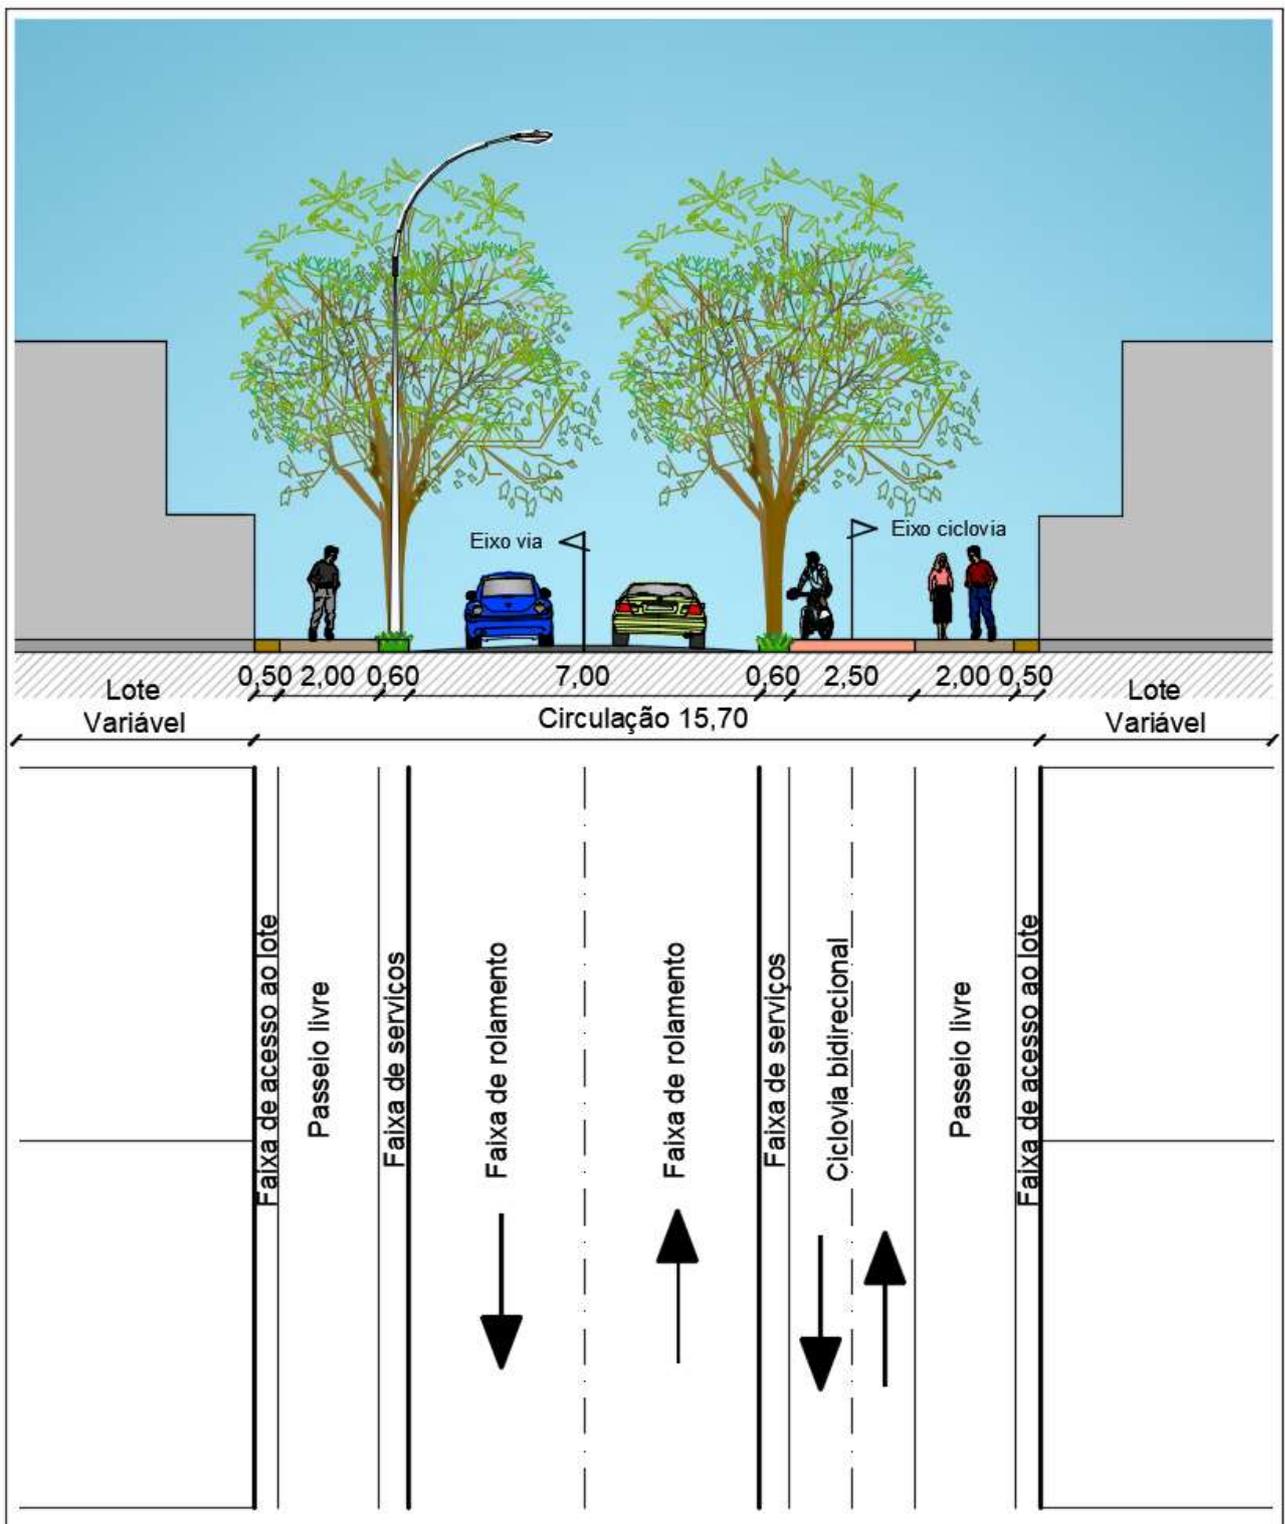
Perfil 5 – Rua Reserva Planaltina (Via de Circulação 1)
